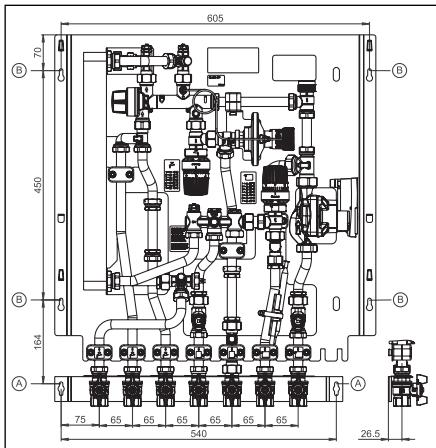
Schema di collegamento barra di fissaggio valvole a sfera 1341180
